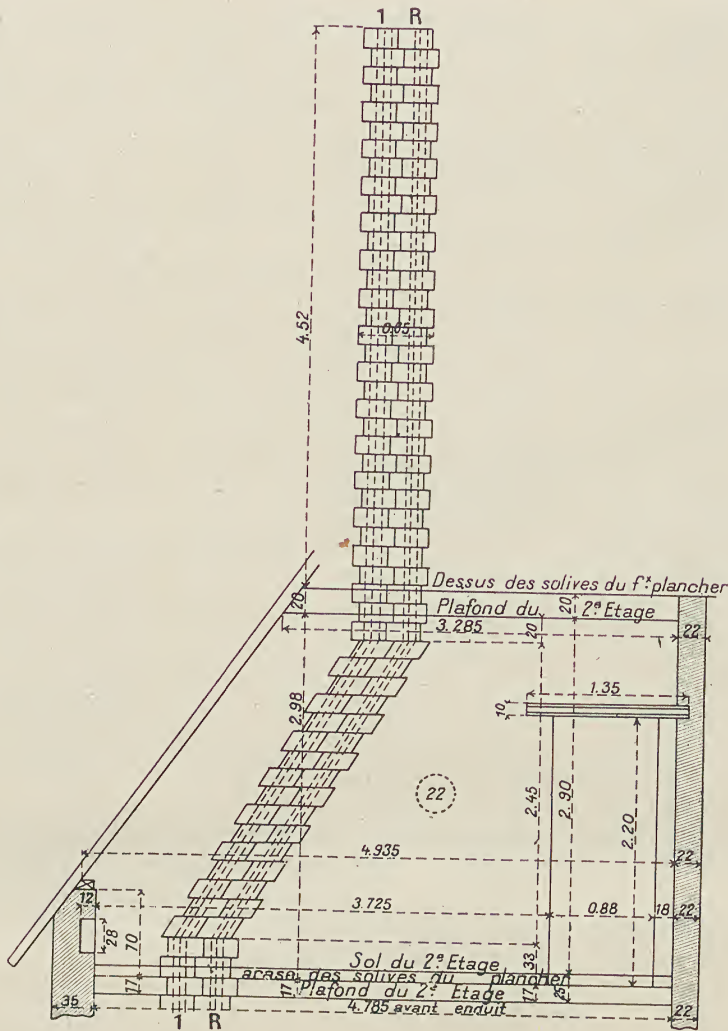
1^{er} mur de refend parallèle à la façade principale.
